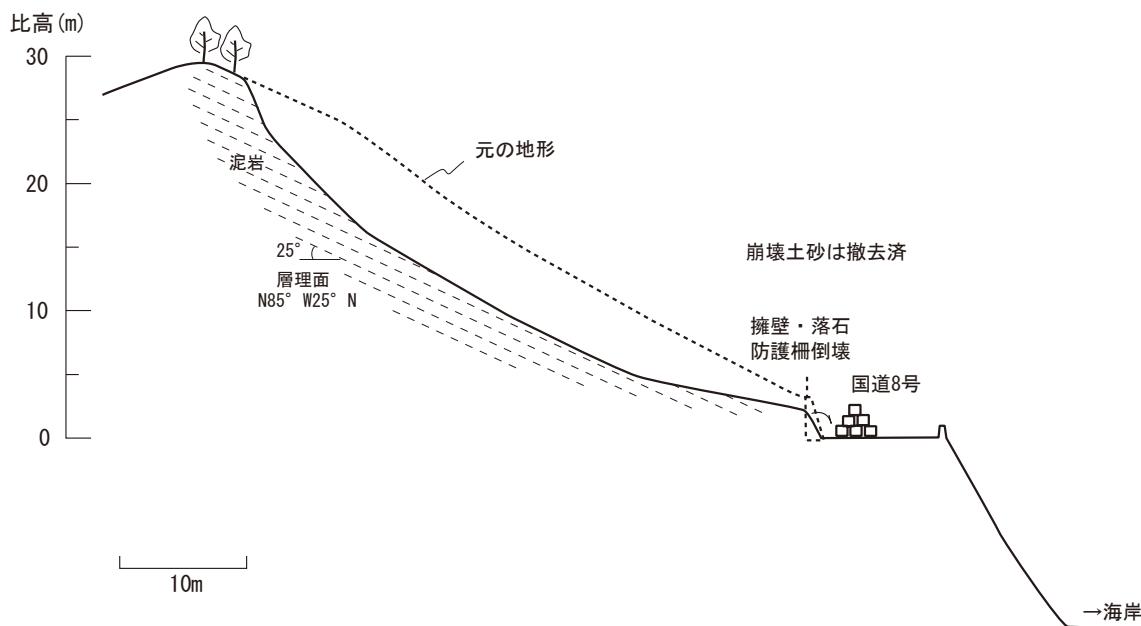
岩盤崩壊箇所（斜面B）断面図
